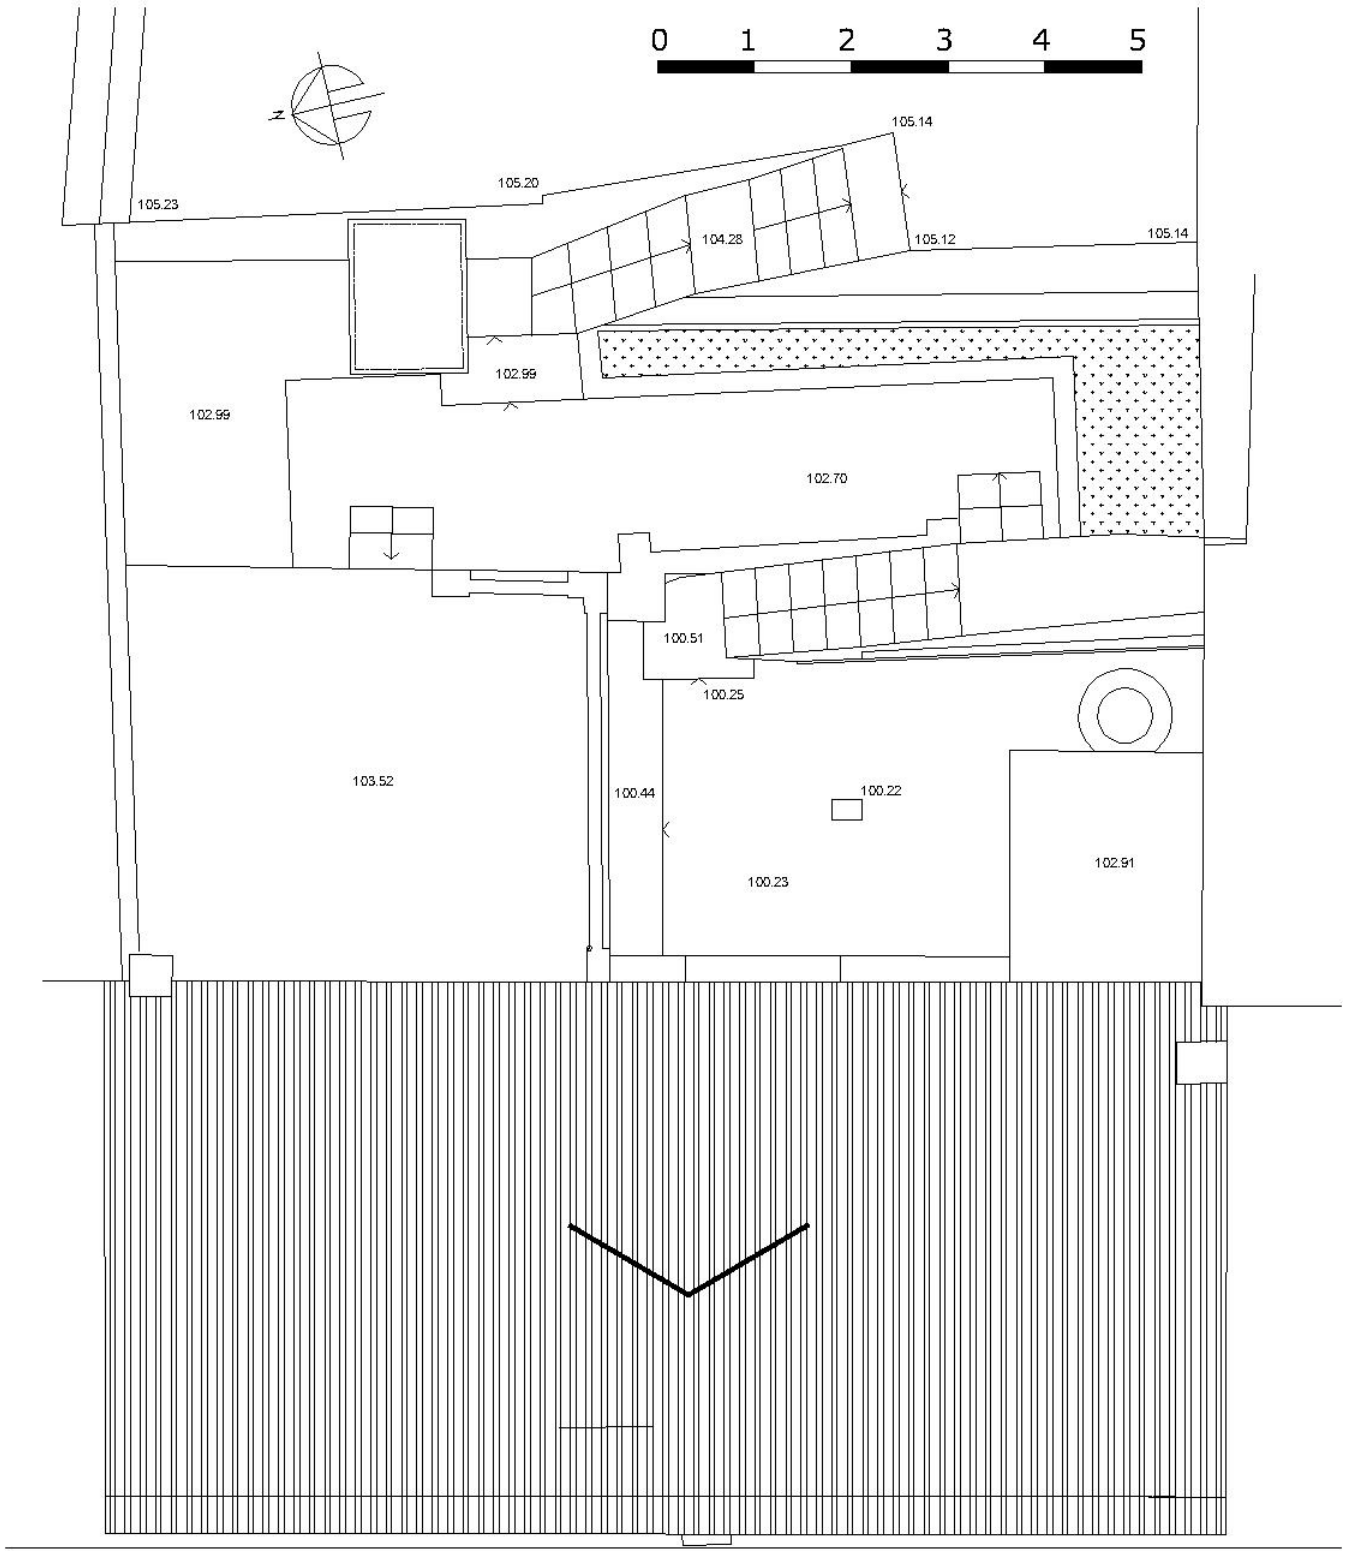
Estado actual de la vivienda sita en calle Llum, 9. Planta cubierta
